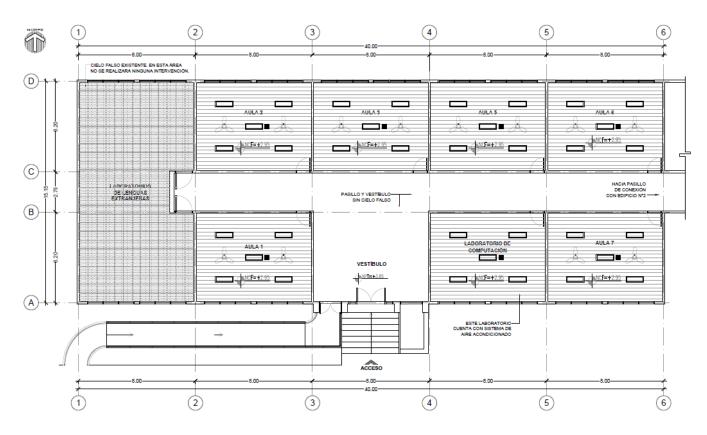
Planta de cielos reflejados y ventiladores, Segundo nivel Edificio N°1
